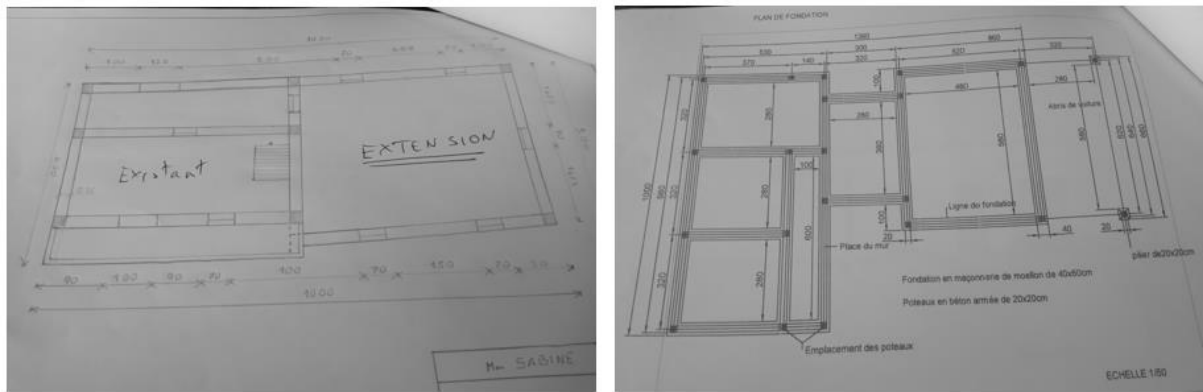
Plan réalisé à la main (à gauche) et sur Autocad (à droite)
